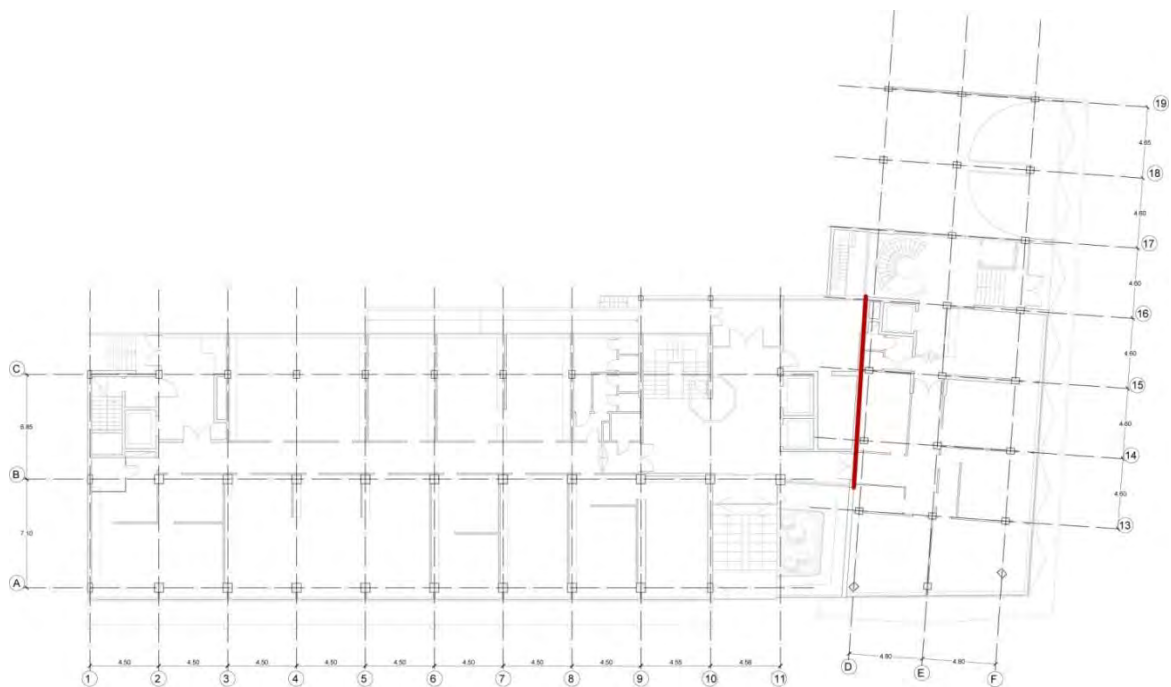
Pianta piano terra con assi dei pilastri che formano una griglia regolare
